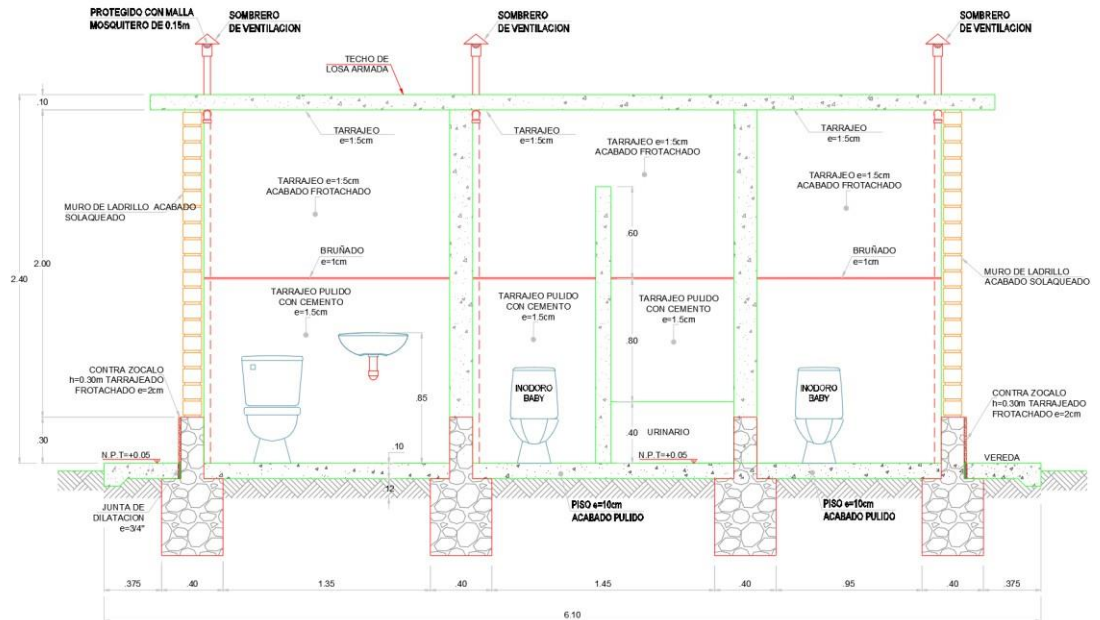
Propuesta de Plano corte de la UBS en la I.E.
